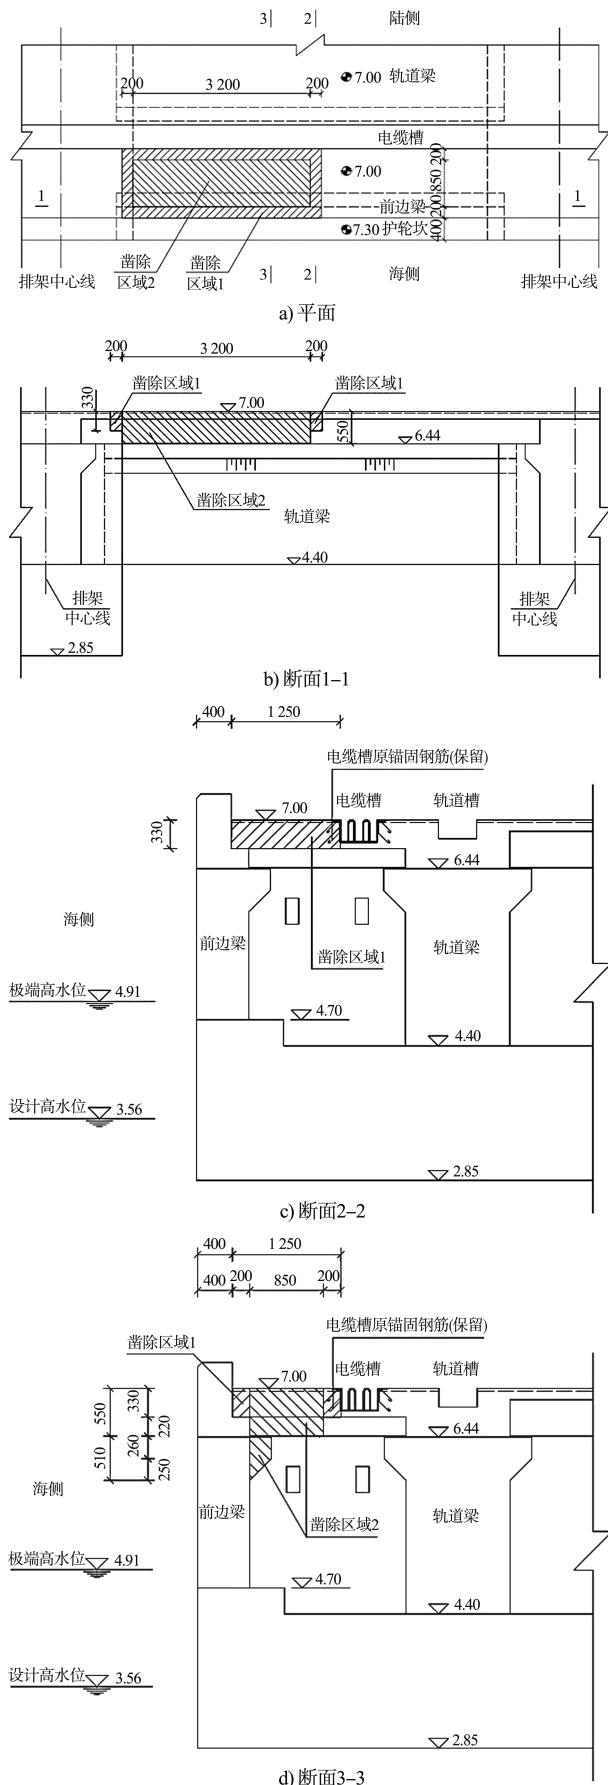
老码头结构凿除平面及断面 (高程: m; 尺寸: mm)
